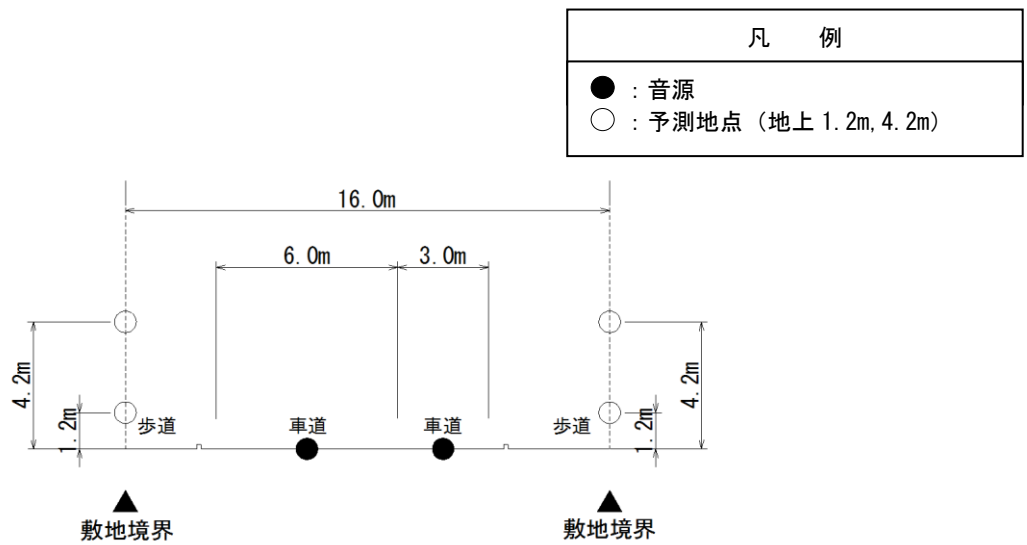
(3) 予測断面图 (C. 一般国道464号(1))
